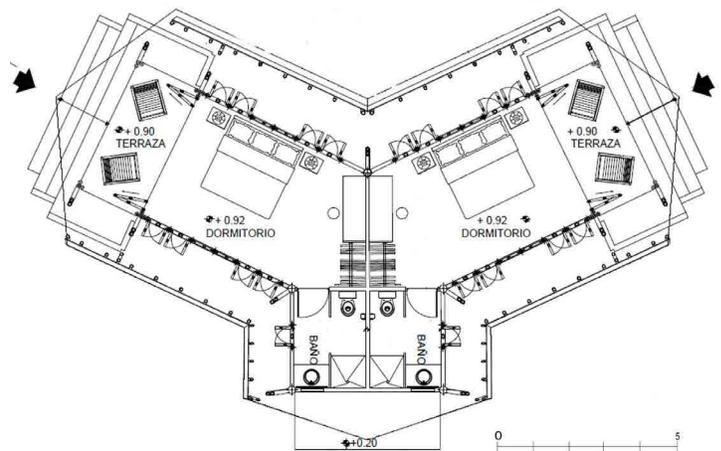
Esquema en planta de un módulo de dos cabañas. Fuente: autores, 2018.
